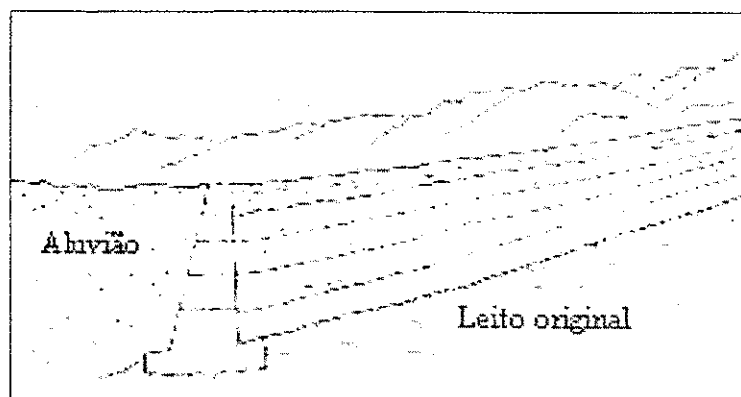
Esboço das características gerais de uma barragem de assoreamento construída por etapas de construção e assoreamento (fonte: adaptado de HANSON & NILSSON (1986)).
